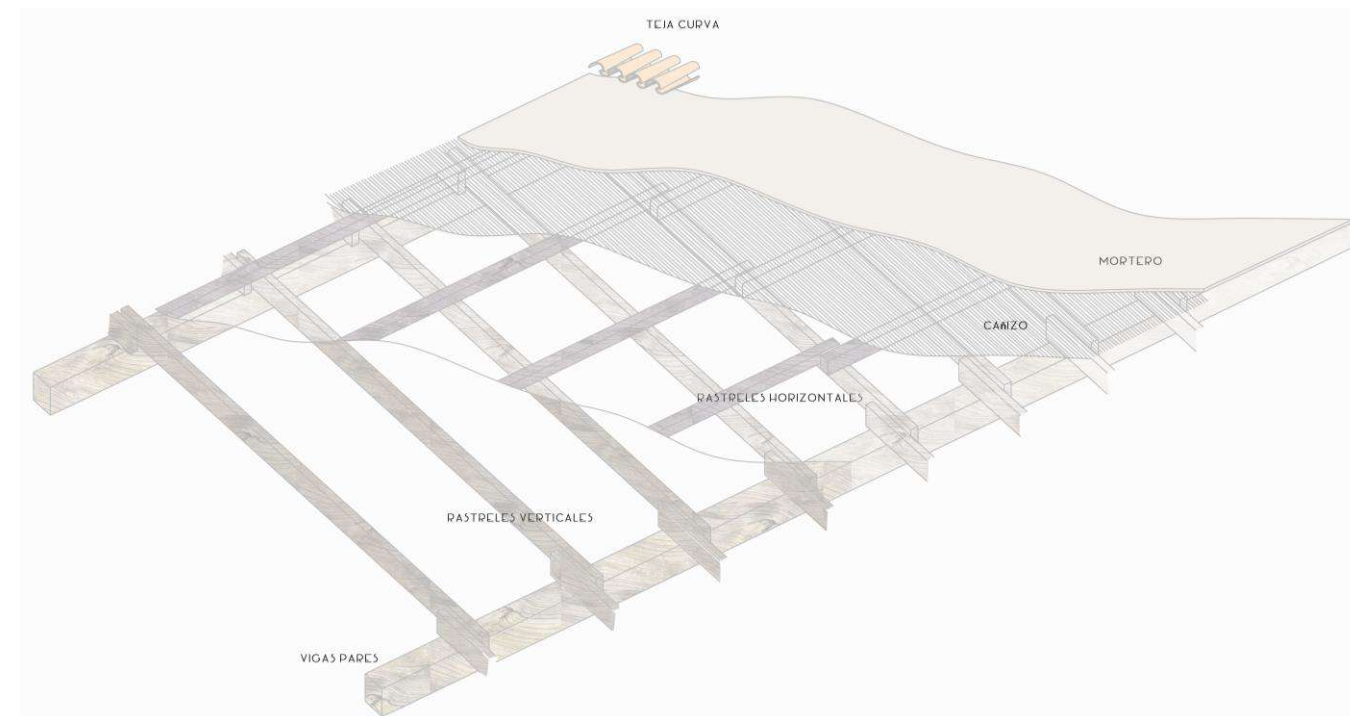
Cubierta de la nave lateral. Fuente: Elaboración propia
